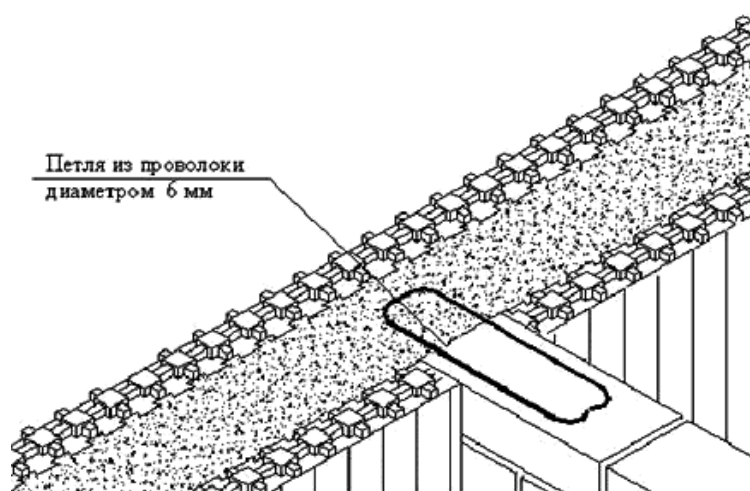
Соединение наружной стены и внутренней перегородки
